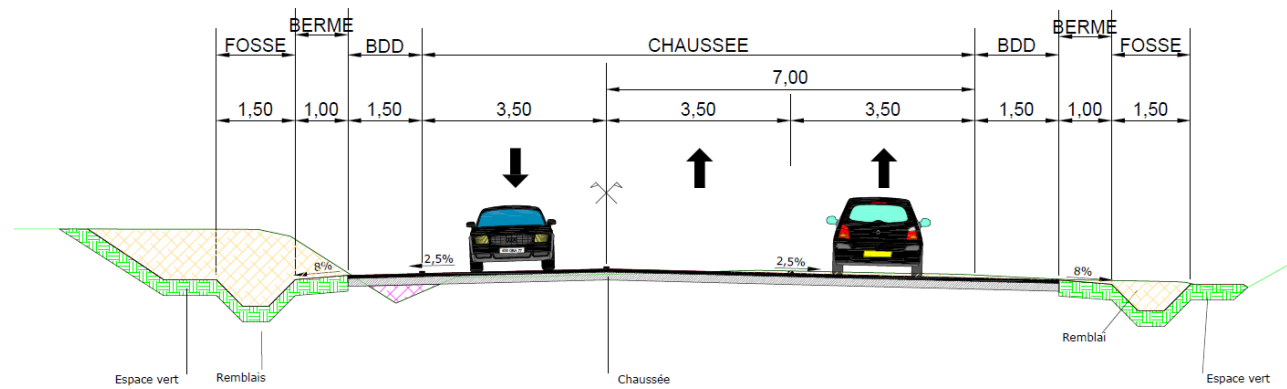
Profil en travers de la RD6 en section à 3 voies
